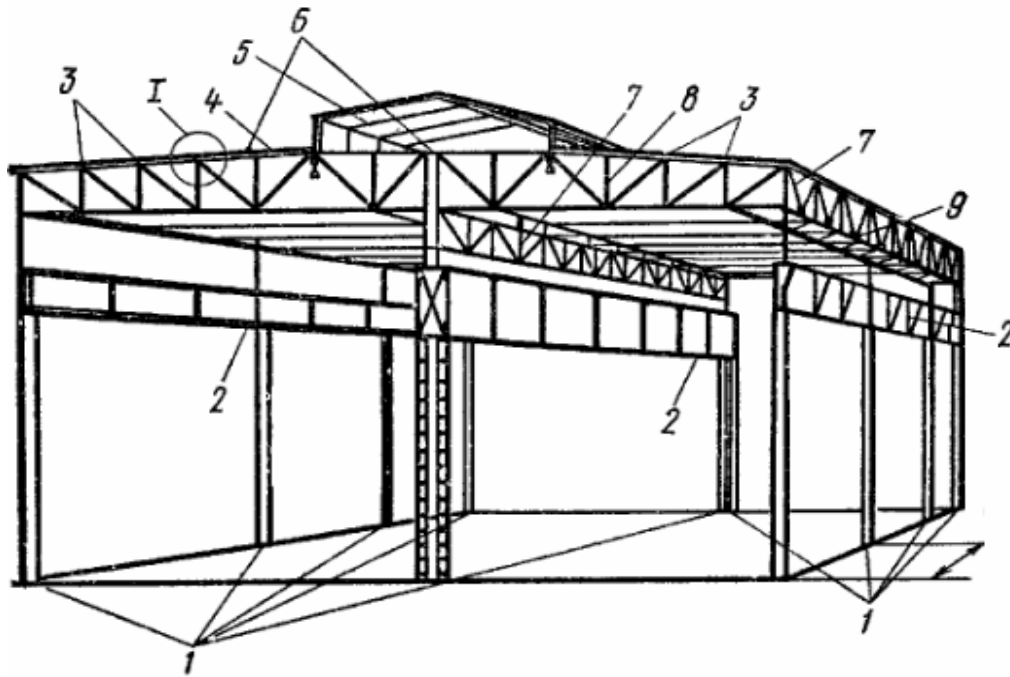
Конструктивна схема каркасу одноповерхової промислової будівлі: 1 – колони, 2 – підкранові балки, 3 – прогони, 4 – покрівля, 5 – світлоаераційний ліхтар, 6, 9 – в'язі, 7 – підкрівляна ферма, 8 – підкрівляна ферма
